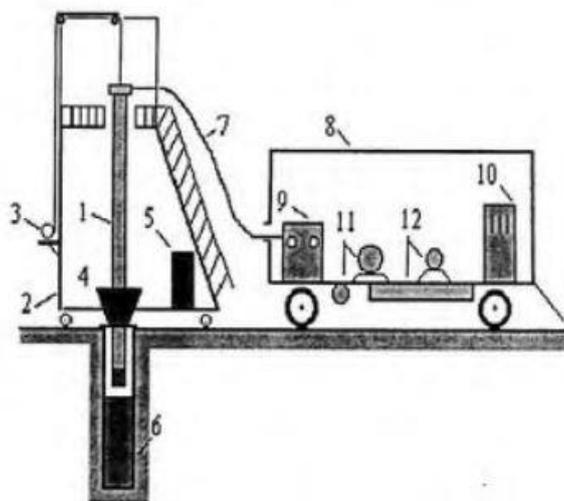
схема опытно производственной установки для изготовления грунтоплавленных свай:
